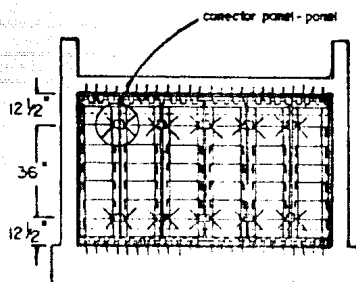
d.) Muro con paneles precolados múltiples, espécimen 4.
